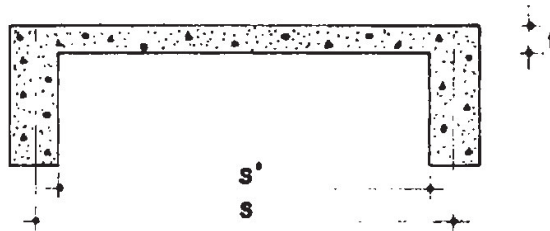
Tablero simplemente Apoyado sobre vigas.
